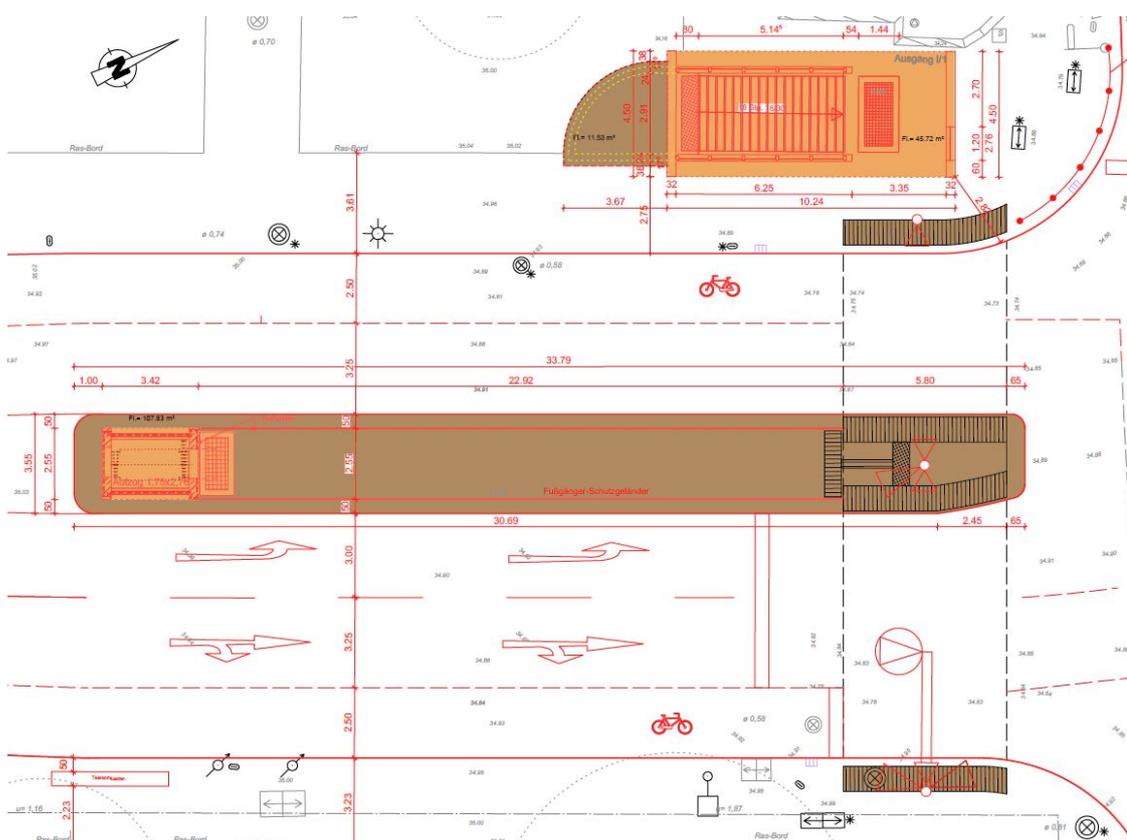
Instandhaltungsf lächen, Ausschnitt Plan He\_PG005
